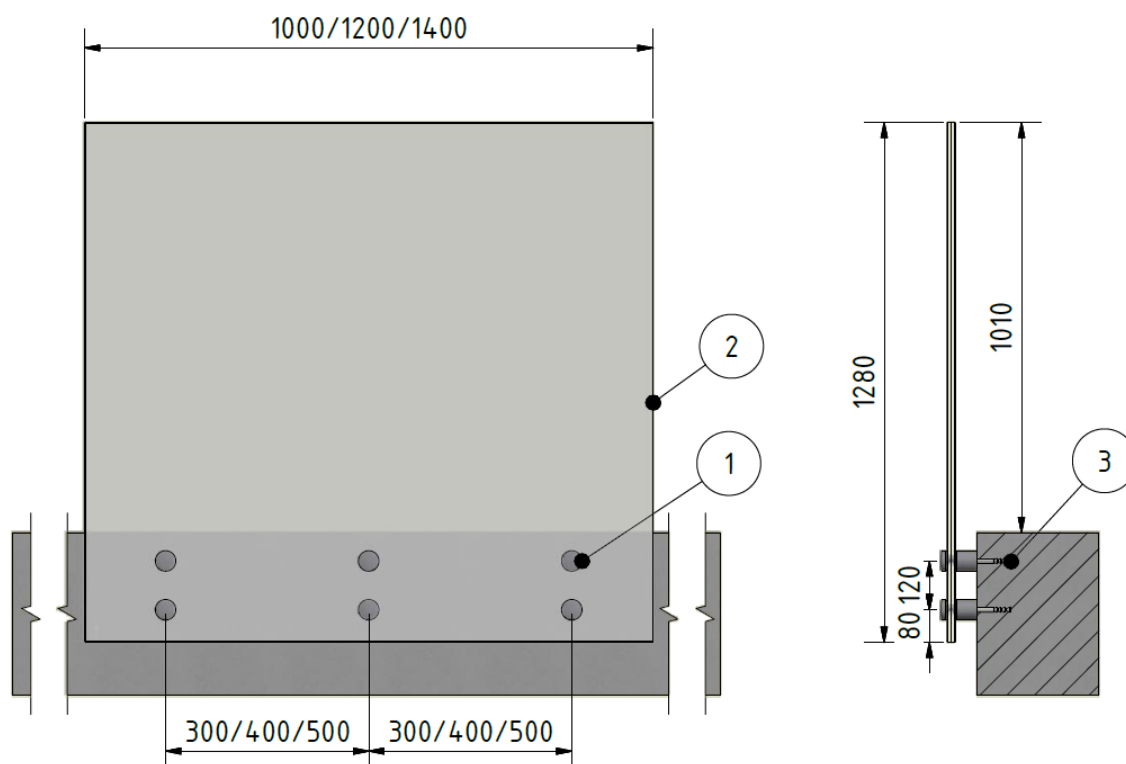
Vue de face (à gauche) et coupe transversale (à droite) du garde-corps avec mention des dimensions des vitrages
